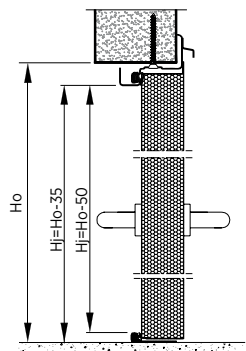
Montage einflügeliger Türen mit Eckzarge an der Stahlkonstruktion - Vertikalschnitt
